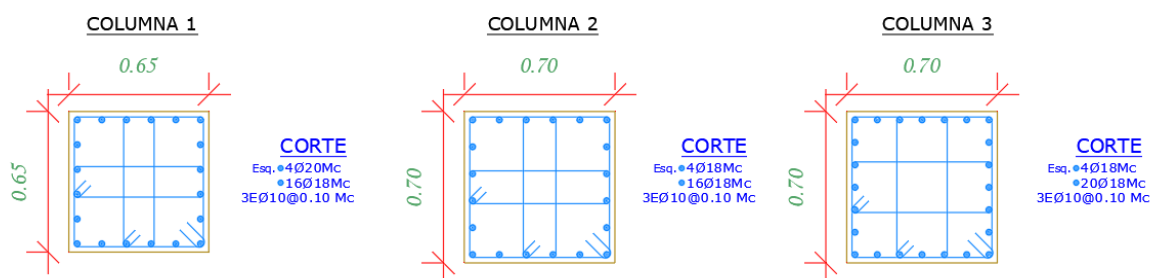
Sección transversal de la columna utilizada en un edificio de 6 pisos.
